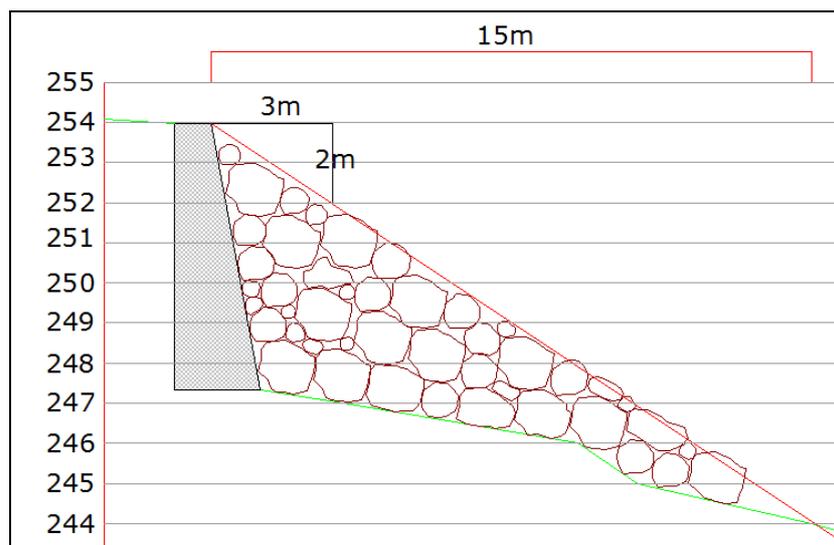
Coupe de principe de l'enrochement en pied du mur de soutènement
